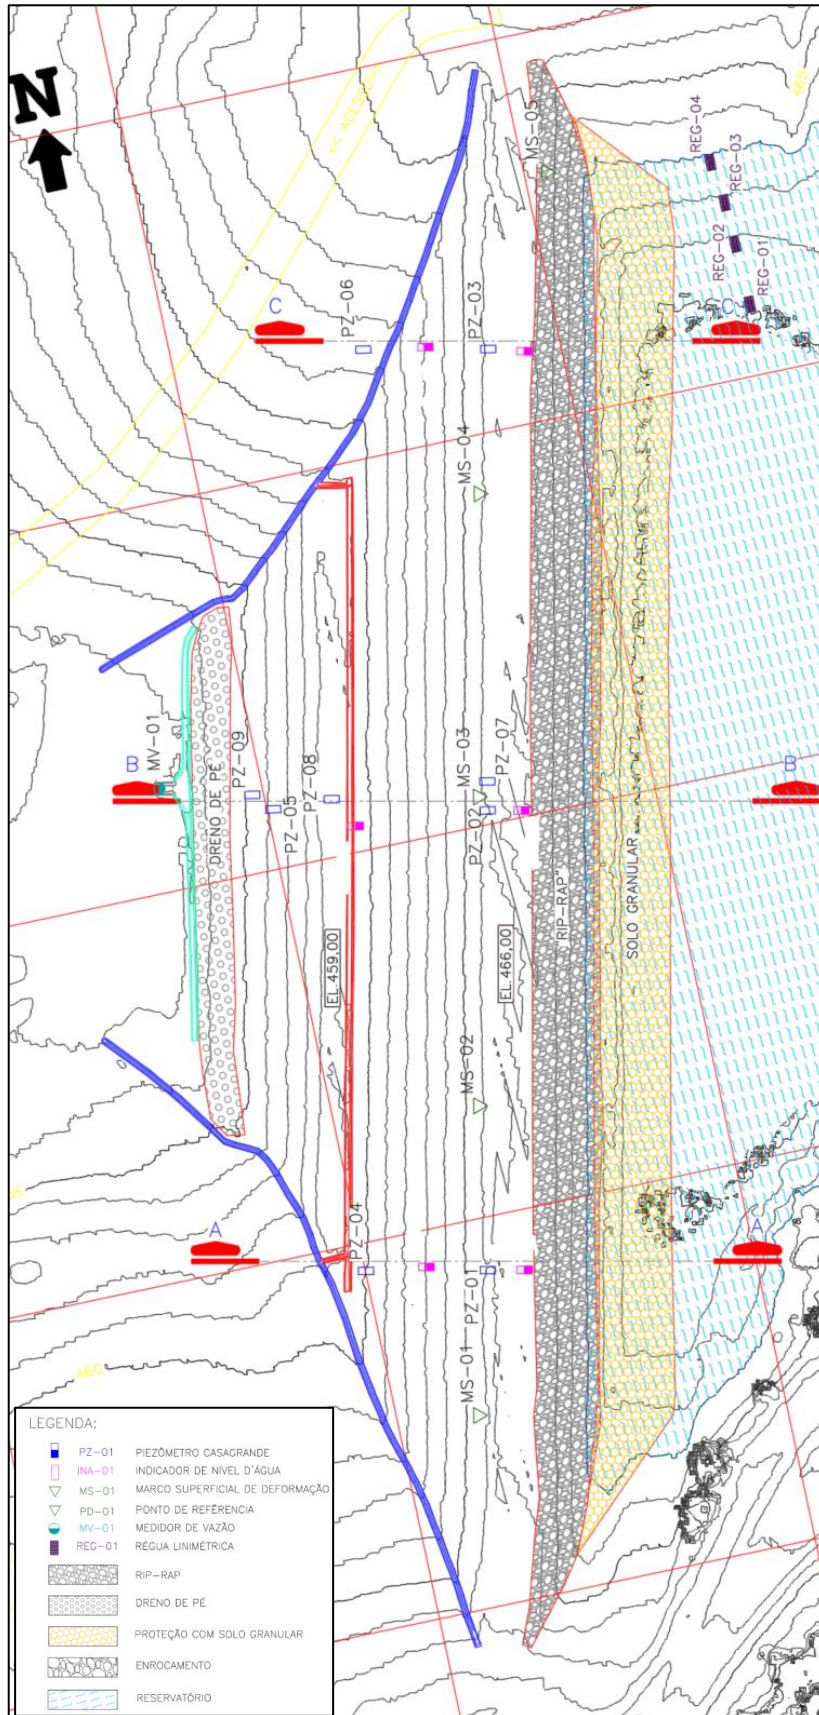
Planta de Locação dos Instrumentos de Auscultação.
